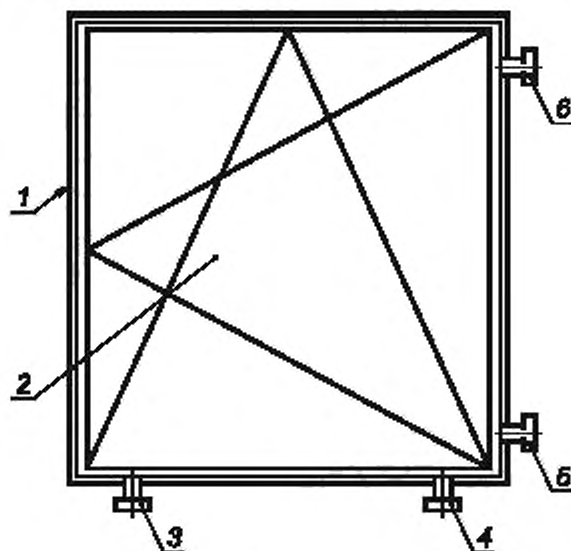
Адаптеры для передачи статической нагрузки на испытуемый образец
